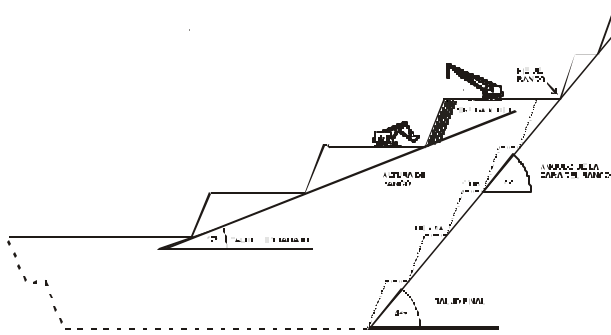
EXCAVADORA UNIVERSAL DE CABLES
